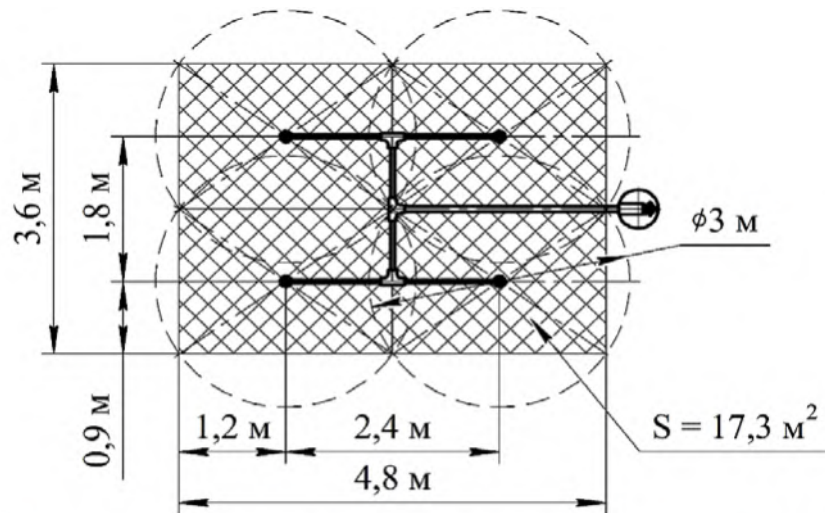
Вариант трубной разводки по вписанным прямоугольникам на 4 насадка-распылителя
